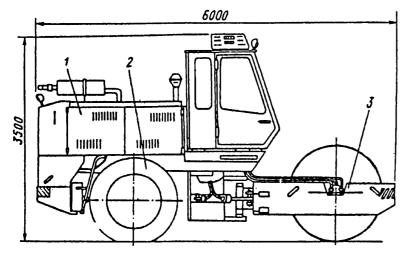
Общий вид дорожного самоходного катка ДУ-62А:
